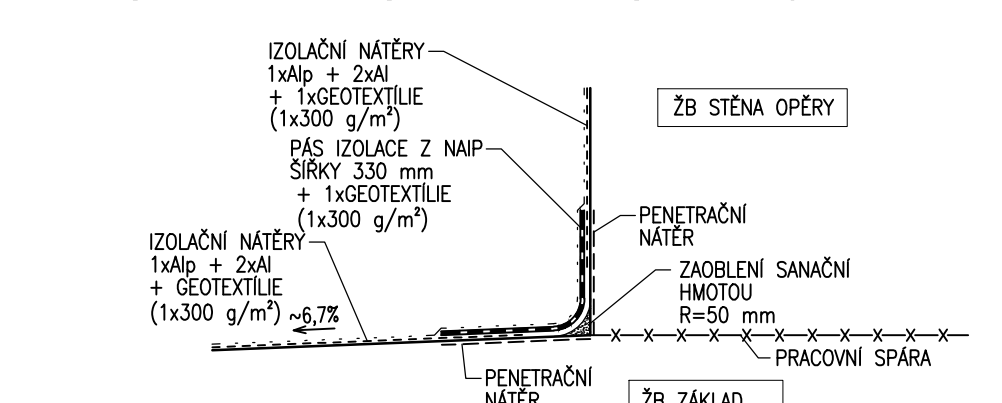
DETAIL ÚPRAVY PRO ODVODŇOVAČE 1:10
